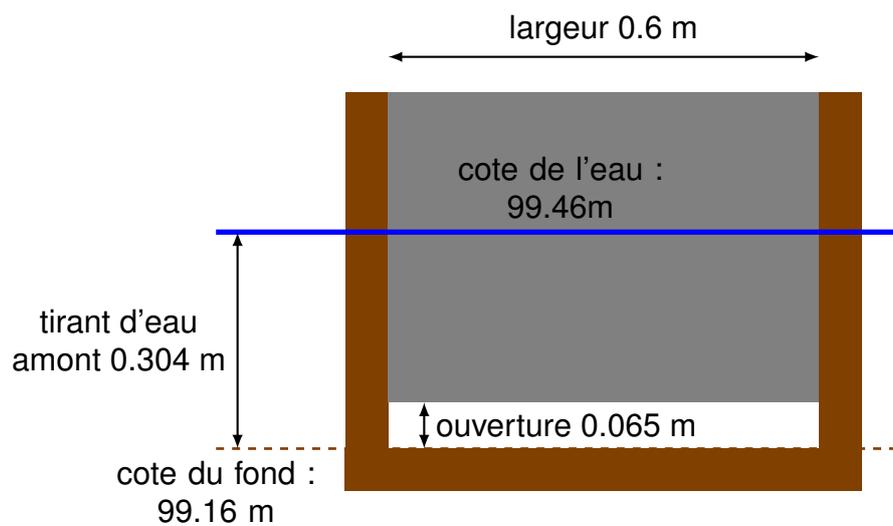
Coupe transversale de la vanne de la prise d'eau du canal rive droite
